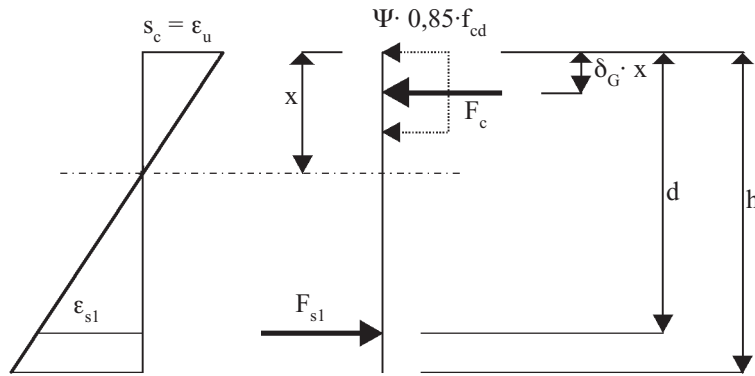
Cálculo de la sección transversal de la viga no reforzada para el ELU.
